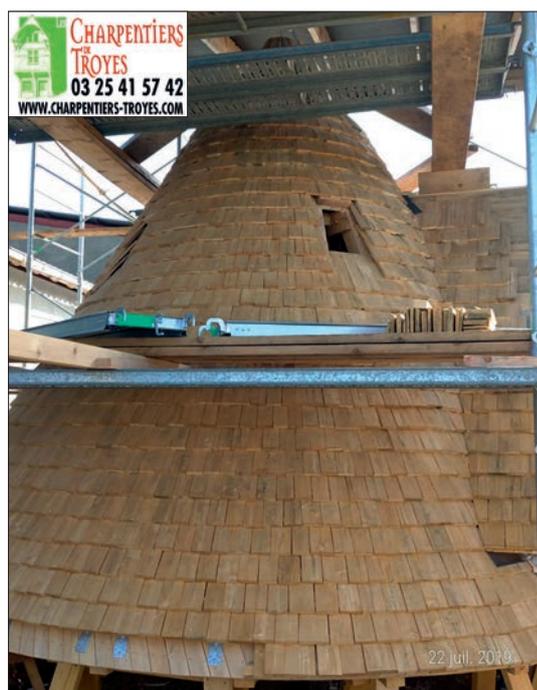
Couverture de la coiffe en bardeaux de châtaigner. Photo © F. Platbrood.
